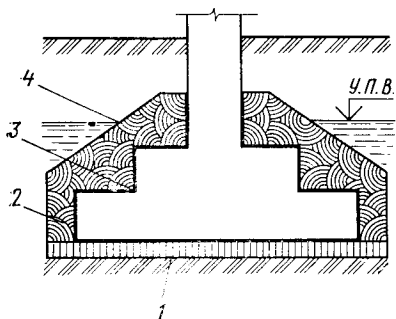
Схема изоляции фундамента от агрессивных вод
